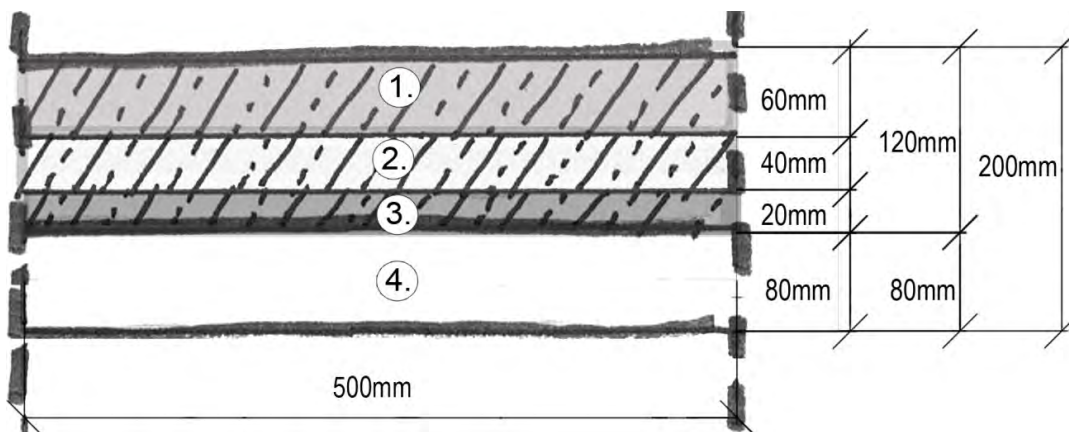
Durchschnittliche Betonmenge, = 120mm Beton Bestand, die kann als Vorlage gestellt werden, Hohlraumdecke Bestand_20cm_6cm
